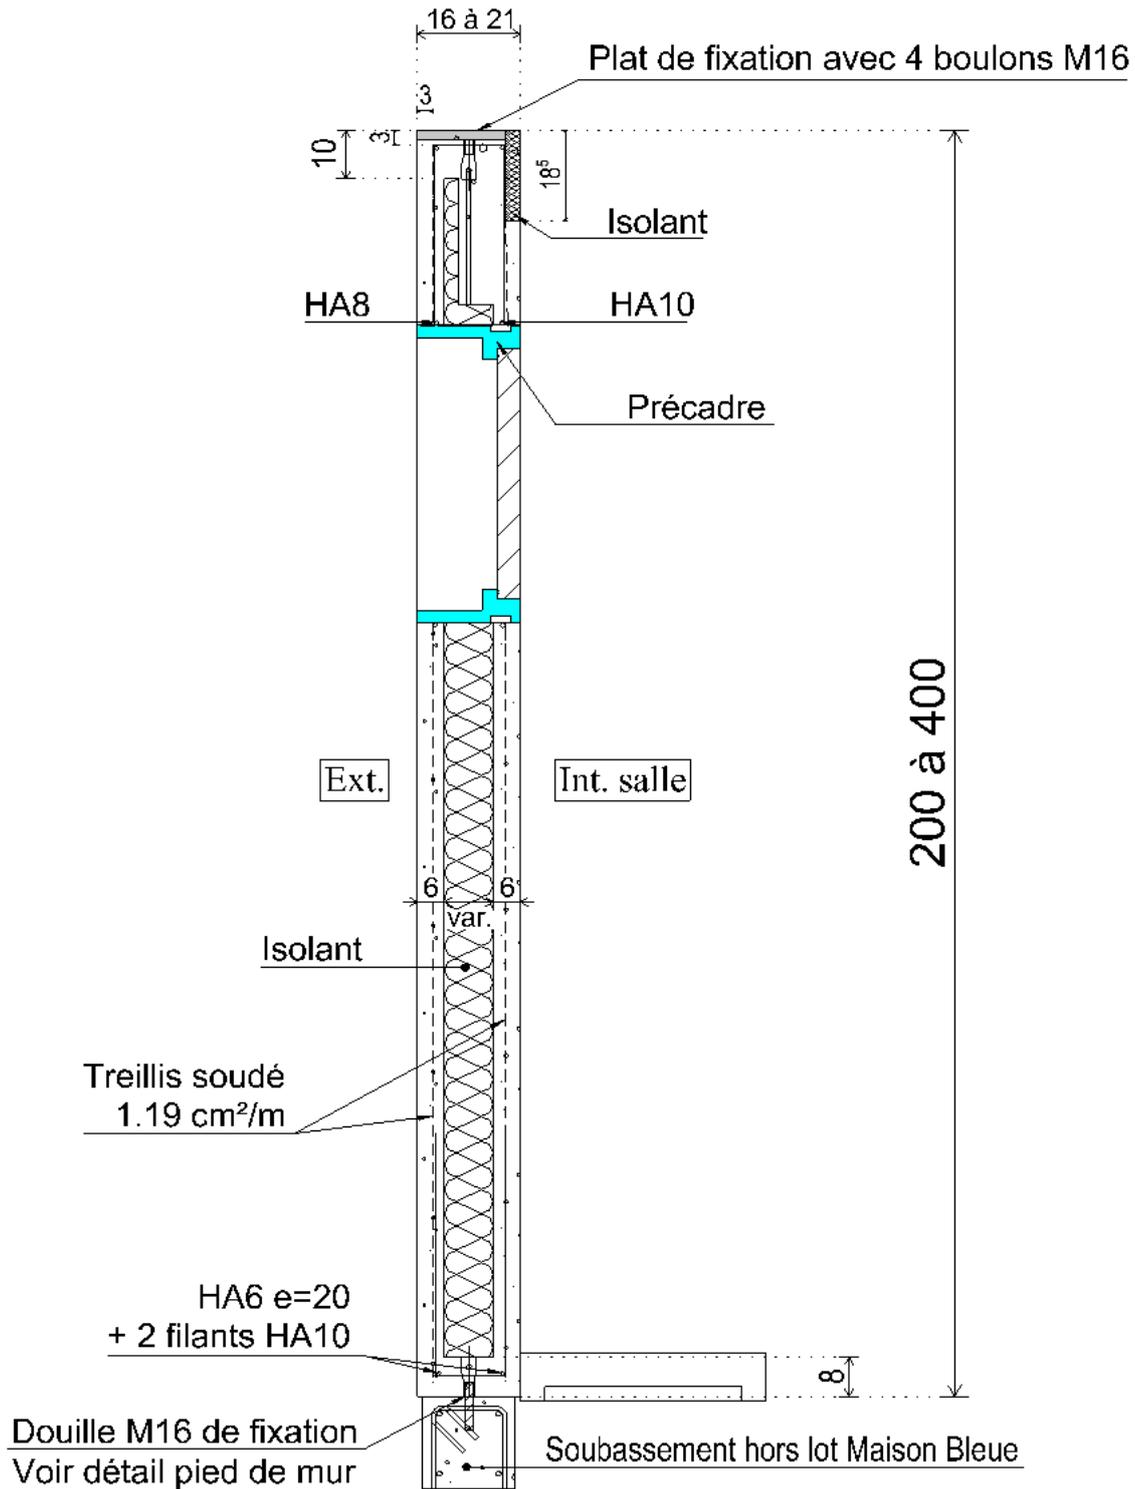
Panneaux sandwichs de façade posés sur soubassement- Type bâtiment d'élevage porcin - coupe verticale – avec réservation en coffrage en bois
